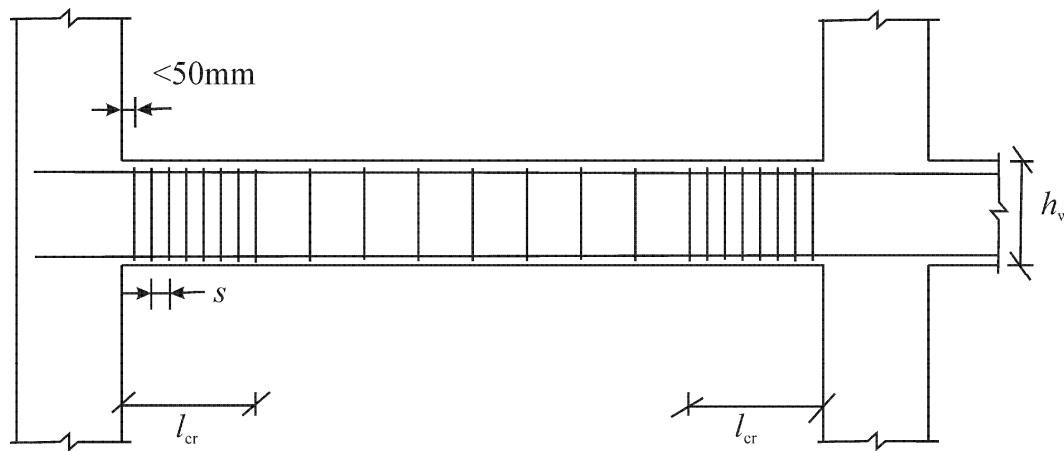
Querbewehrung in den kritischen Bereichen von Balken
